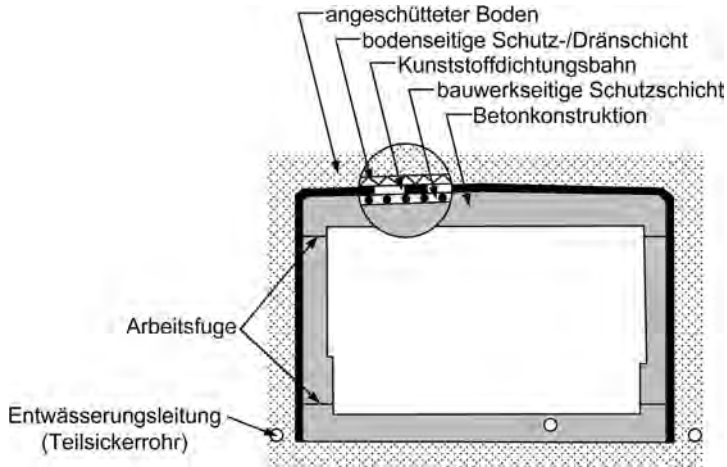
Aufbau eines Dichtungssystems im Rechteckquerschnitt (offene Bauweise, Regenschirmabdichtung).
